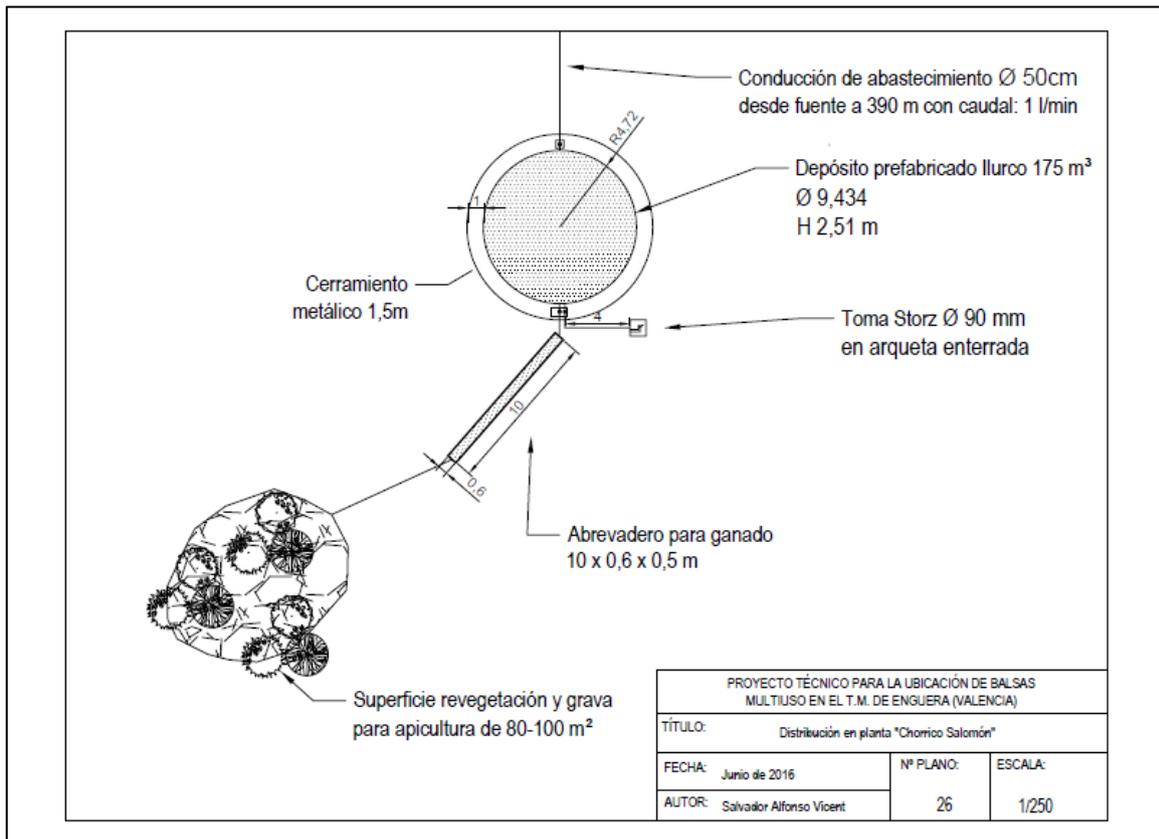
Distribución en planta “Chorrico Salomón”. Fuente: elaboración propia con Autocad
